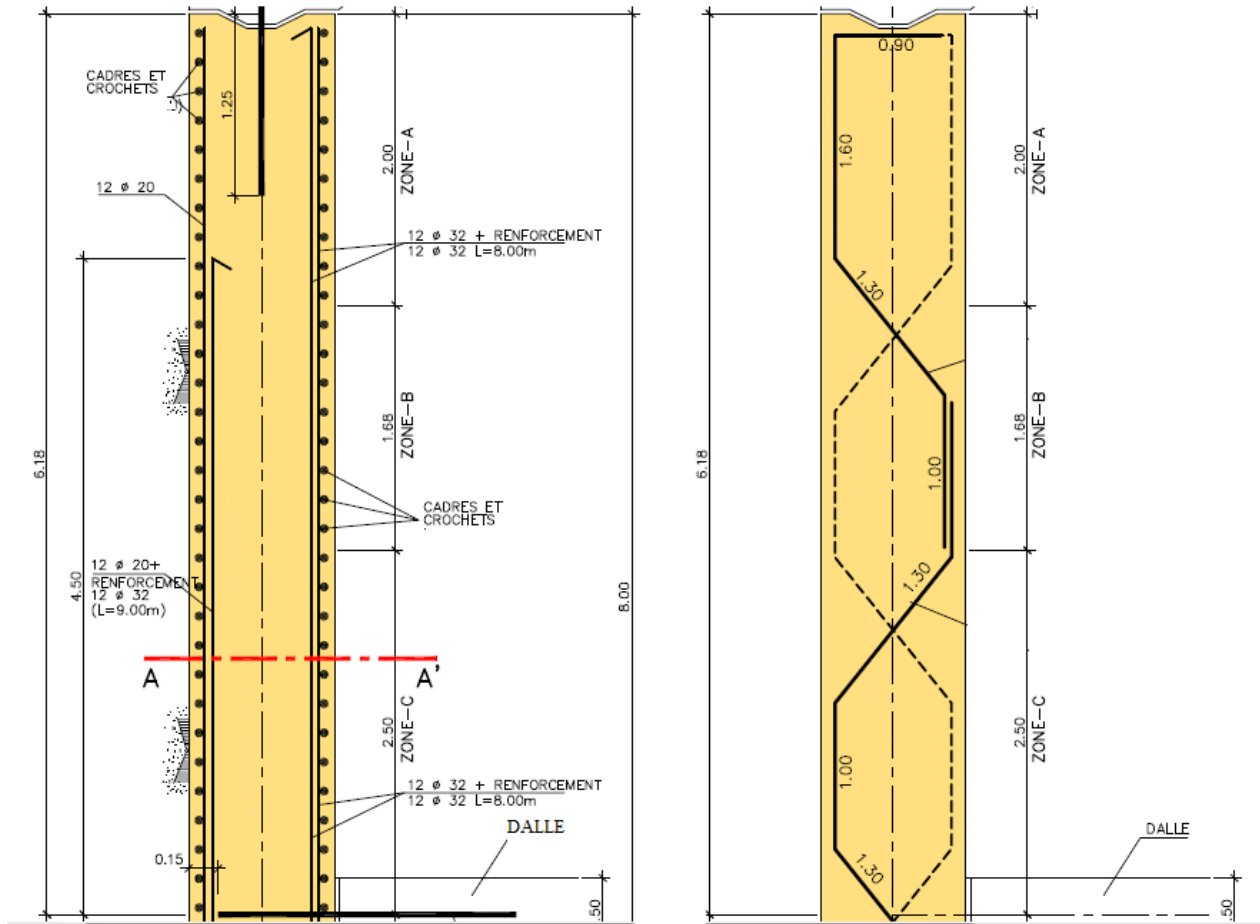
coupe ferrailage de la paroi moulée au dessus de la dalle
